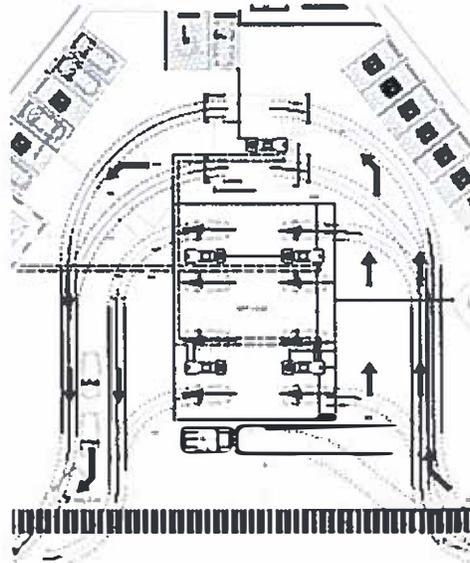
Planta de conjunto patio de servicio y estacionamiento
